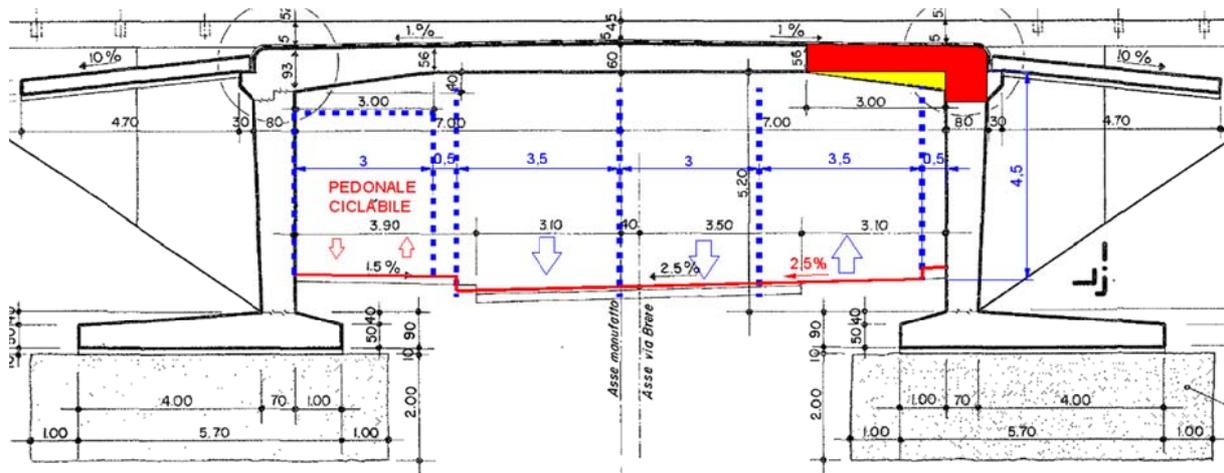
Sezione trasversale sottopasso di via Brere – Variante 3
